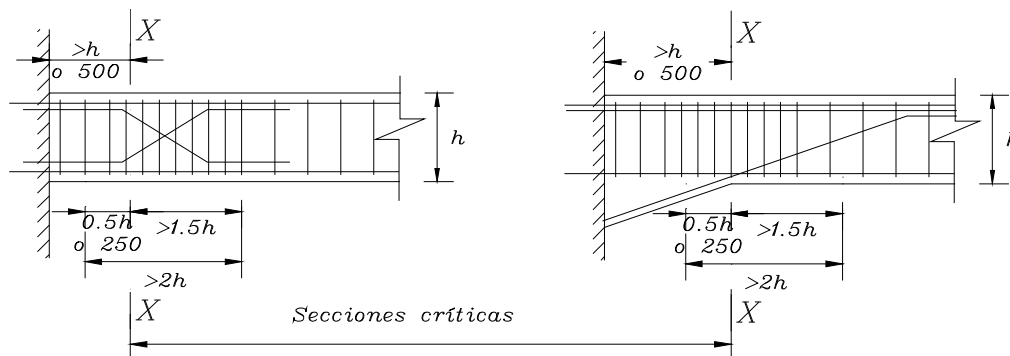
Detalles de rótulas plásticas localizadas lejos de las caras de las columnas
